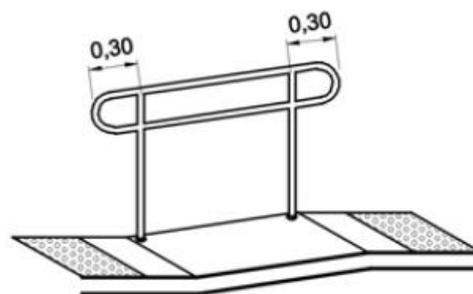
Prolongamento de corrimão de rampas – exemplo.
